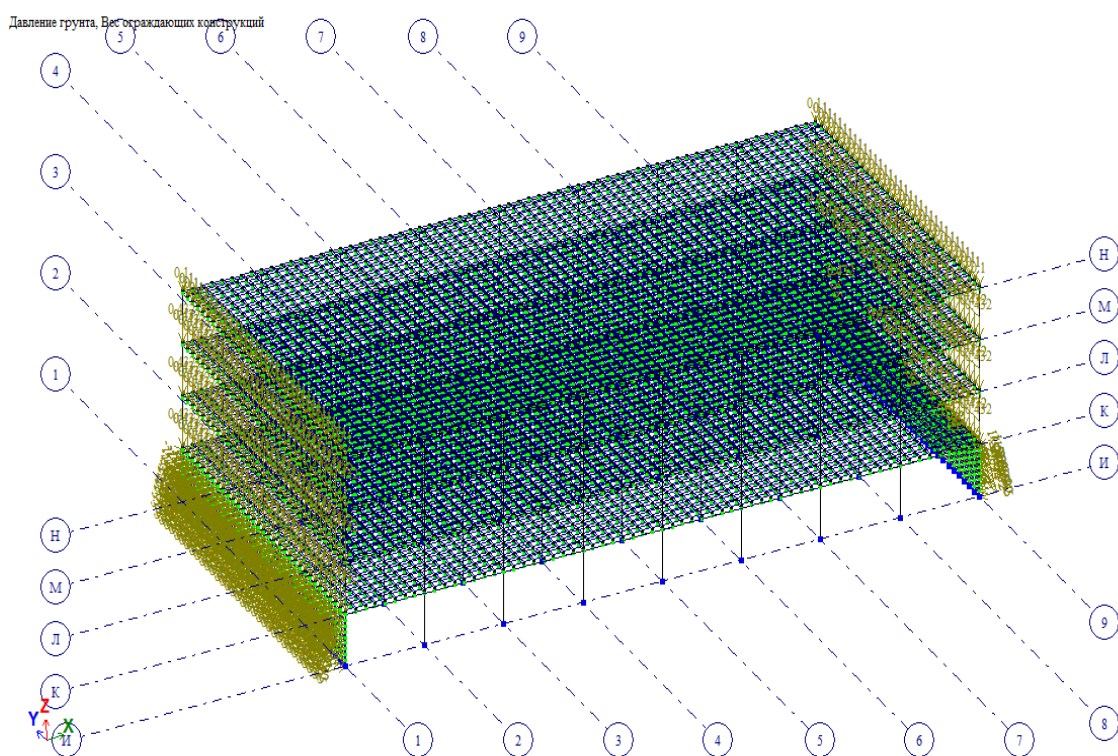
Давление грунта на стены нулевого этажа, вес ограждающих конструкции
